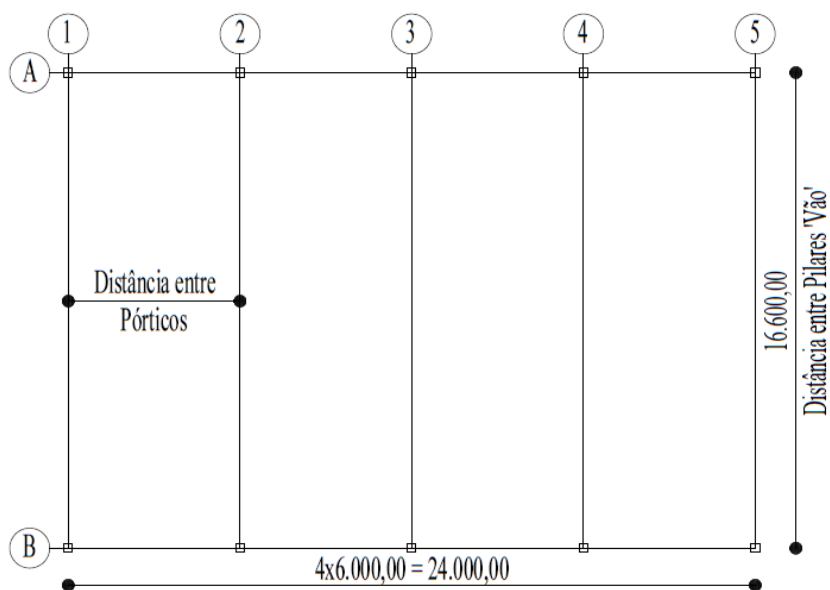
Planta de localização dos pórticos da quadra do Céu Azul, medidas em mm.
